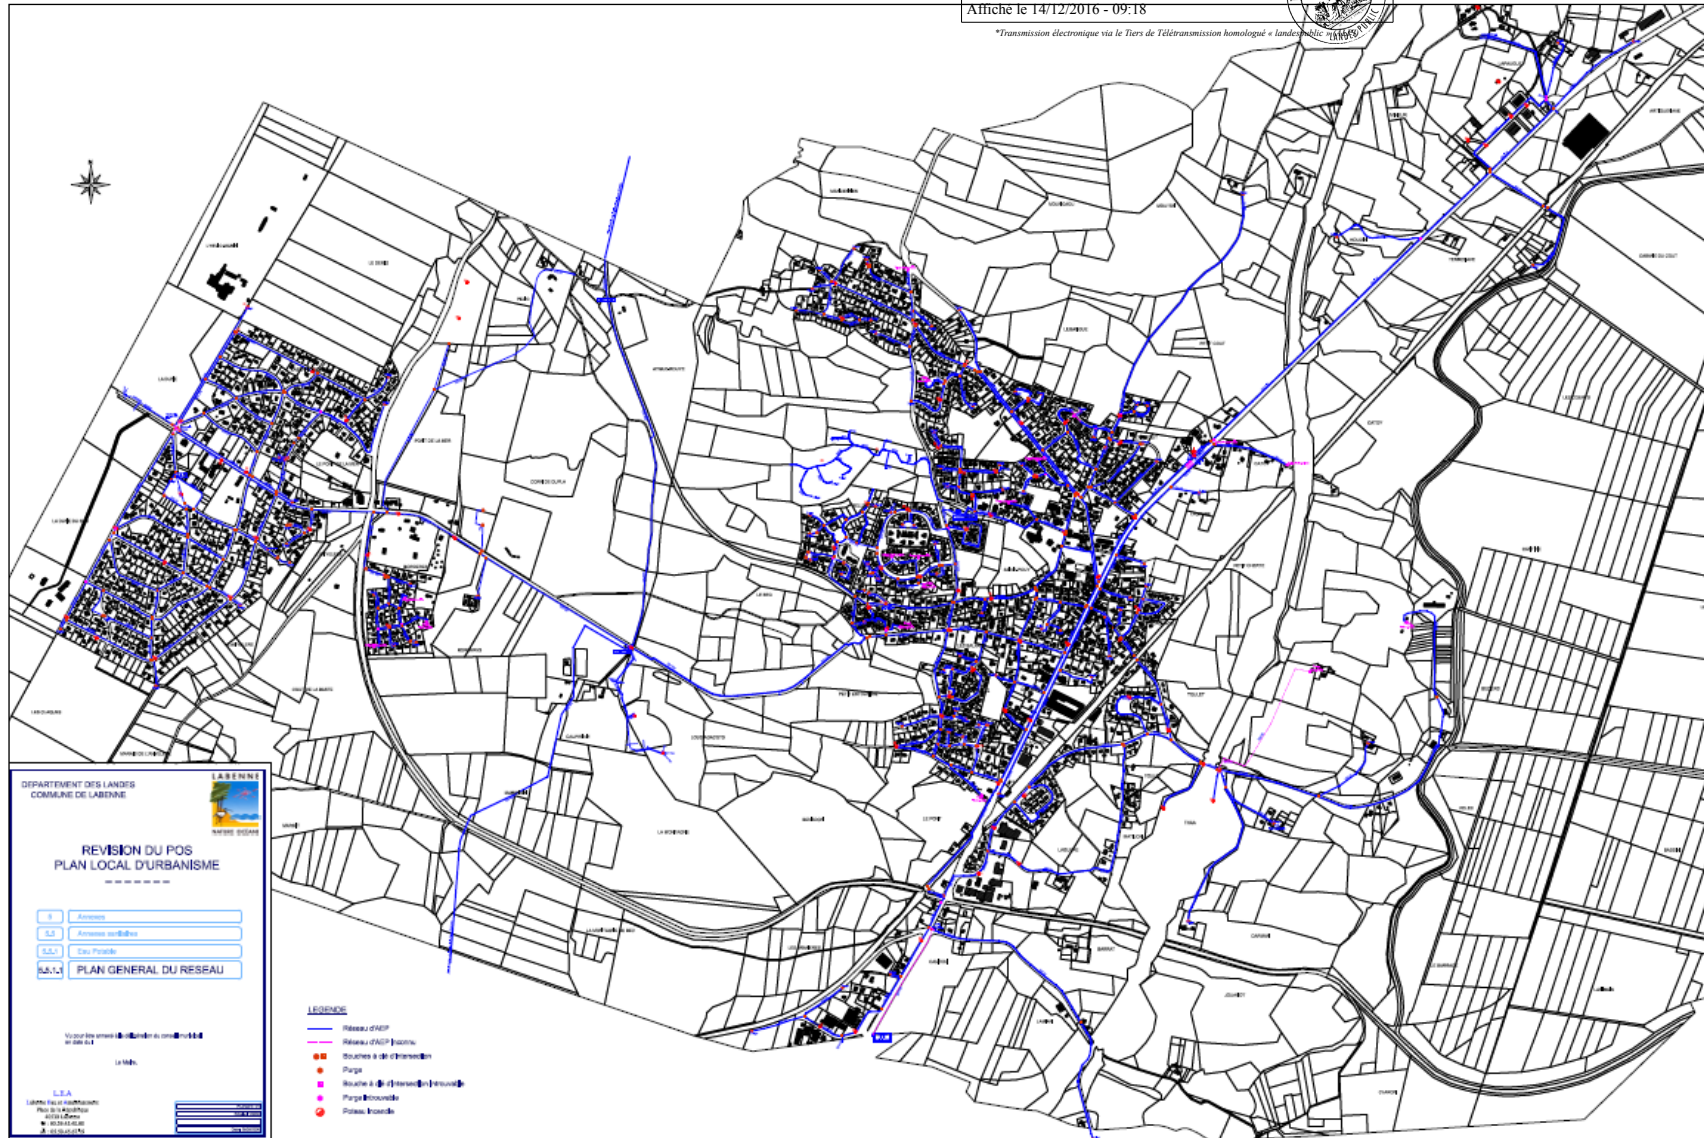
Plan général du réseau AEP en vigueur sur la commune de Labenne
